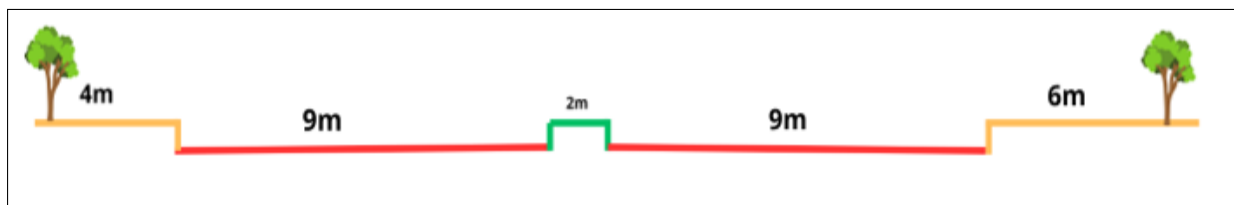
Coupe sur le Boulevard de liberté
